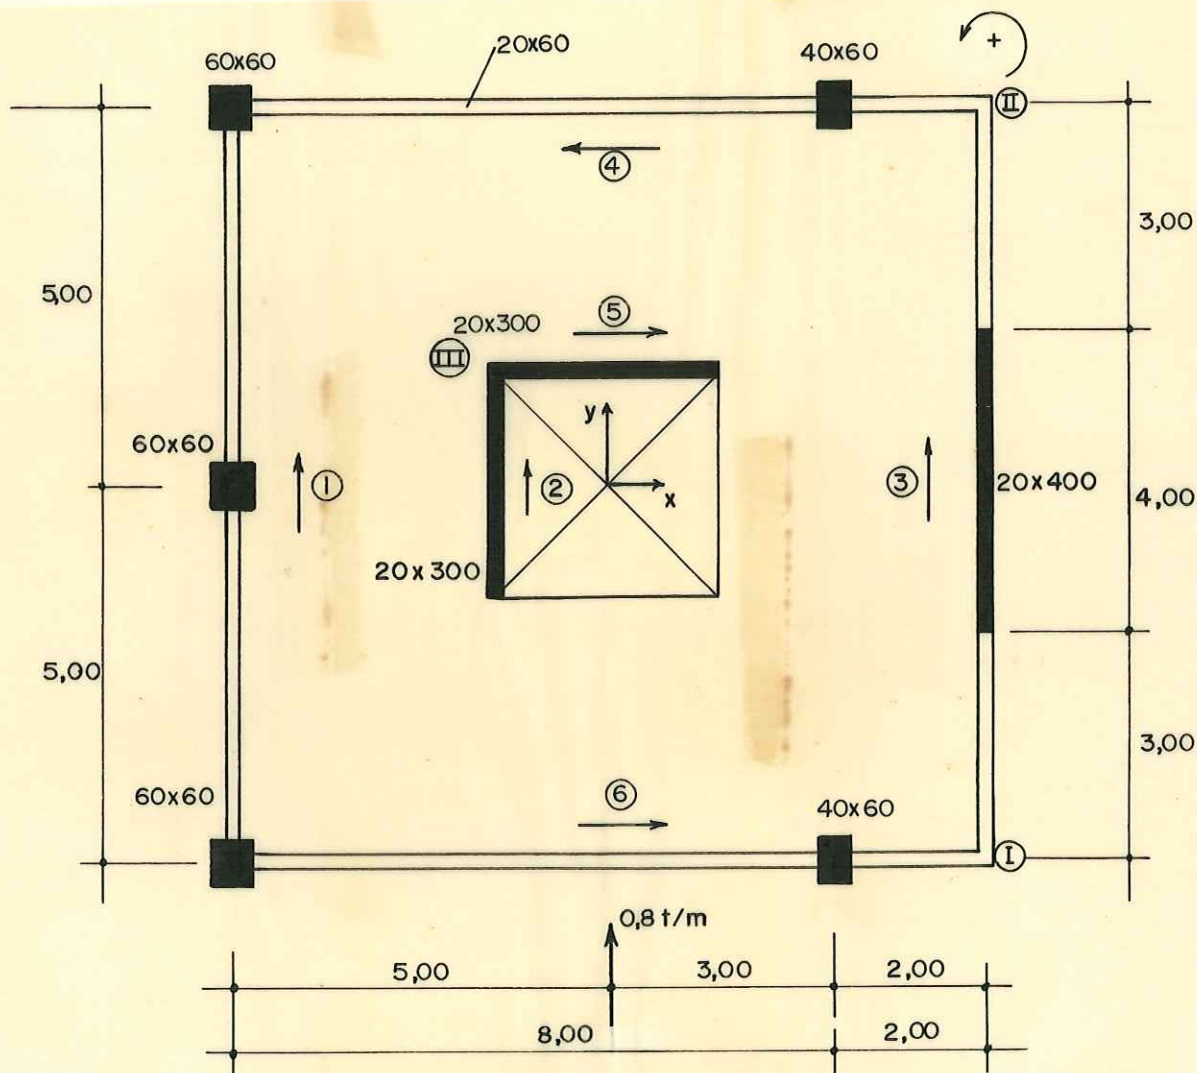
PLANTA DO ANDAR TIPO DO EDIFÍCIO
